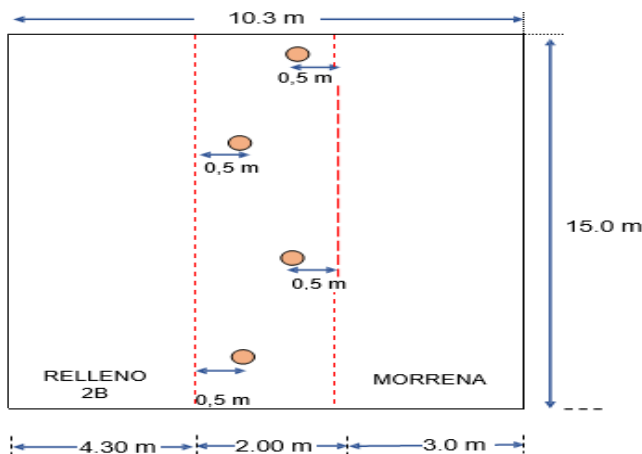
Ubicación de extracción de núcleos en la capa de concreto asfáltico.
